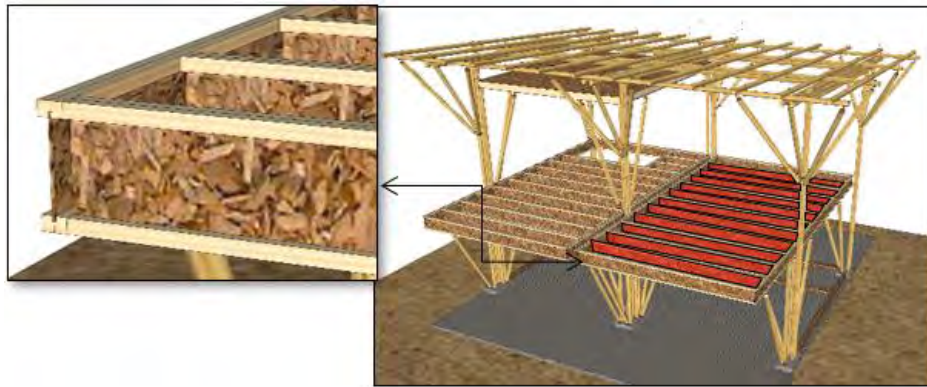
1. Vigas I-Joist en el entrepiso de la estructura
